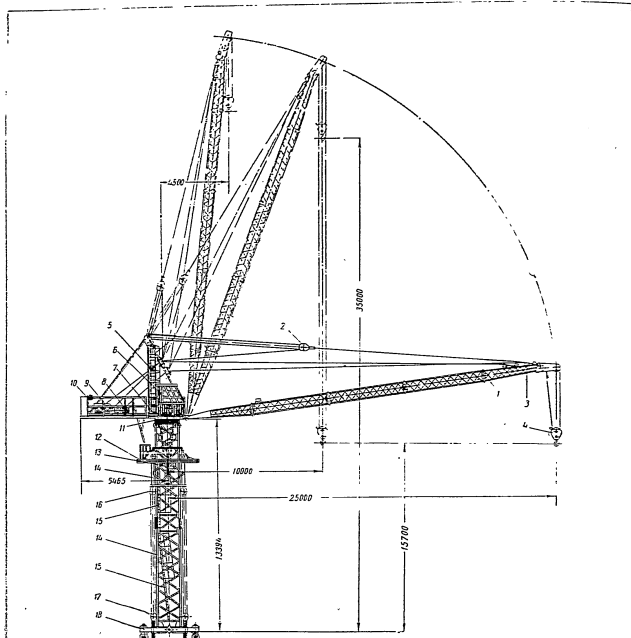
Самоподъемный полноповоротный башенный кран Т-178 с установкой на конструкцию здания: 1 — стрела; 2 — полиспаст подъема стрелы; 3 — ограничитель подъема; 4 — крюк с обоймой; 5 — стойка с блоками; 6 — кабина; 7 — поворотный механизм; 8 — лебедка подъема груза; 9 — стрелоподъемная лебедка; 10 — противовесная консоль с механизмами; 11 — верхние опорные катки; 12 — опорная клетка; 13 — нижняя опора хвостовика; 14 — башня; 15 — лестница; 16 — верхние блоки полиспаста подъема крана; 17 — нижние блоки полиспаста подъема крана; 18 — опорная балка.
